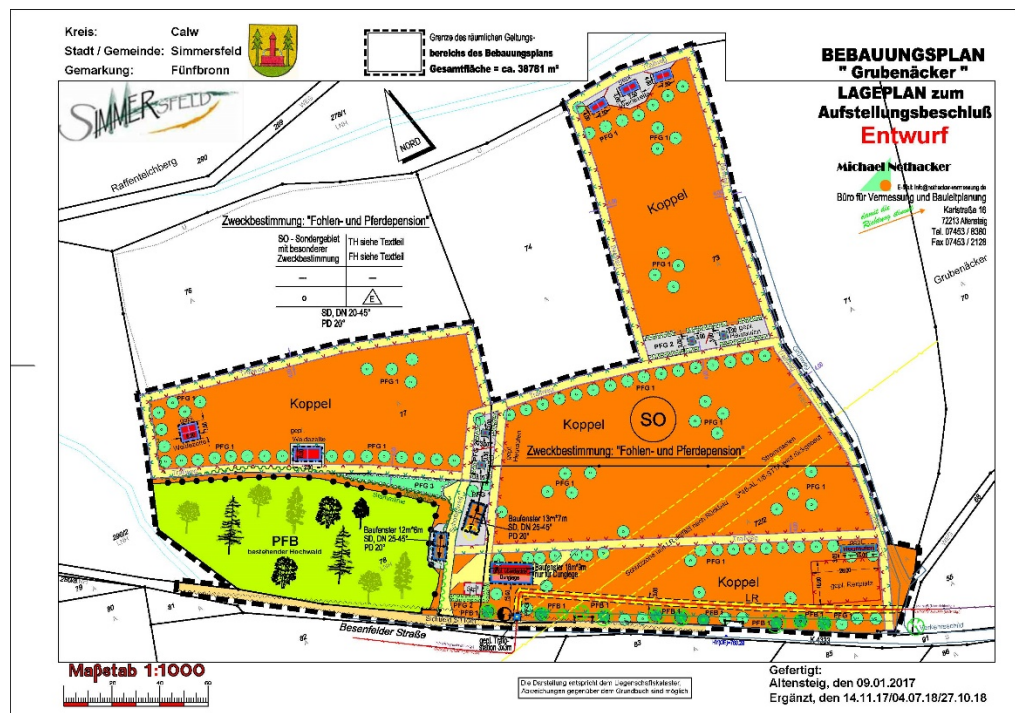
Bebauungsplan „Grubenäcker“, Entwurf
